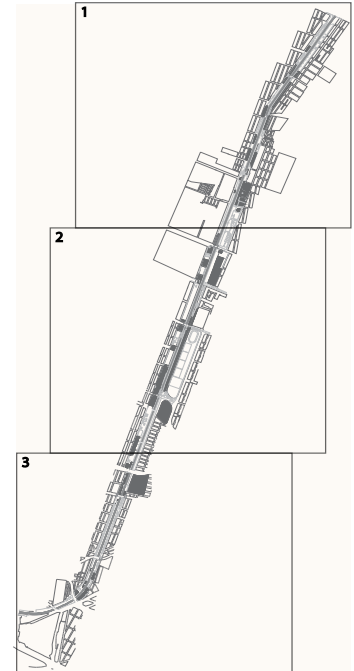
Borde Urbano Av. Gran Canal Plano llave (secciones)
